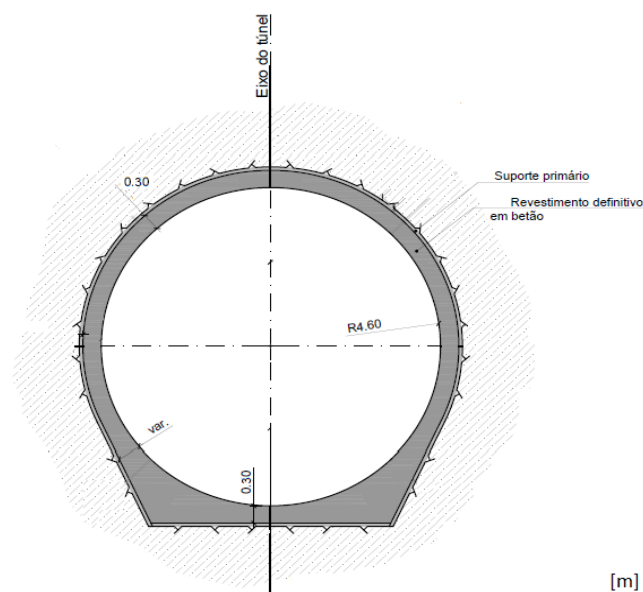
Secção corrente da galeria de restituição dimensionada [9].
